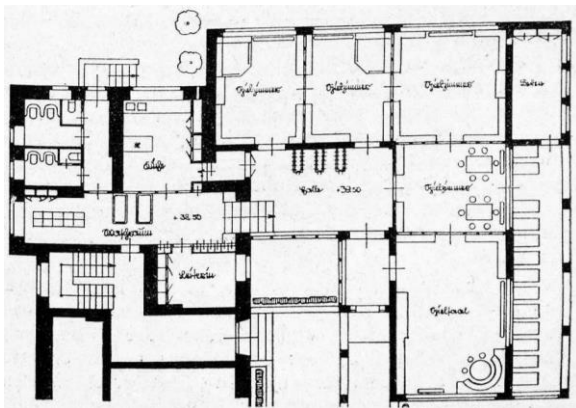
Kindergarten Eisackstraße, Berlin, Grundriss, Lassen, um 1931.
